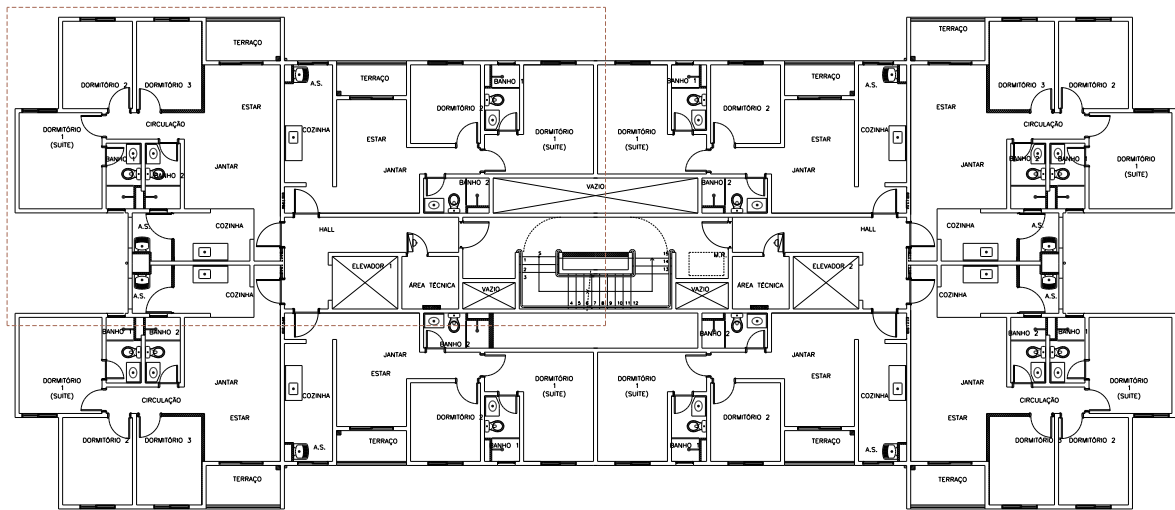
Edifício Way Penha: planta arquitetônica do pavimento tipo
